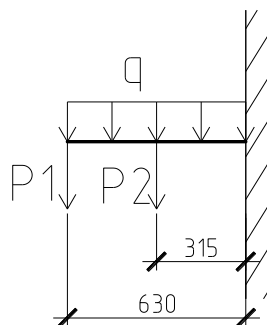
Расчетная схема приложения нагрузки в месте крепления СЖ-1 к колонне
